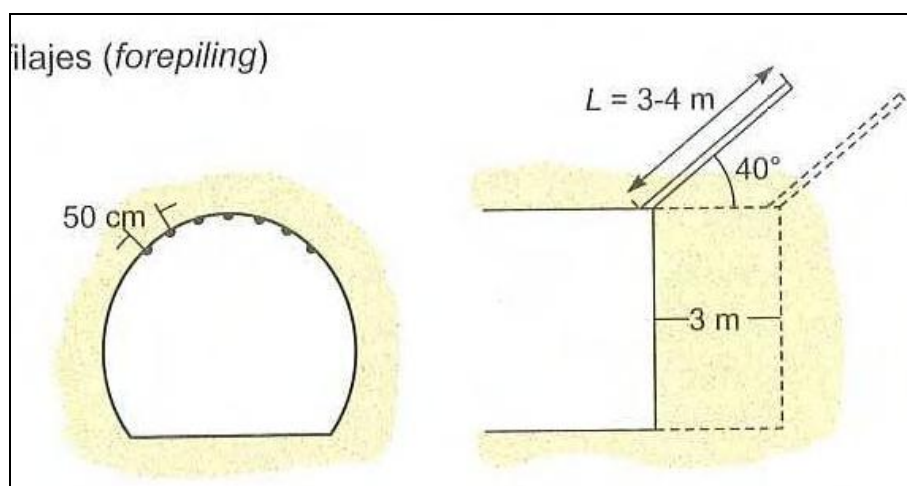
Esquema de instalación de los paraguas ligeros (referencia 4.3).
